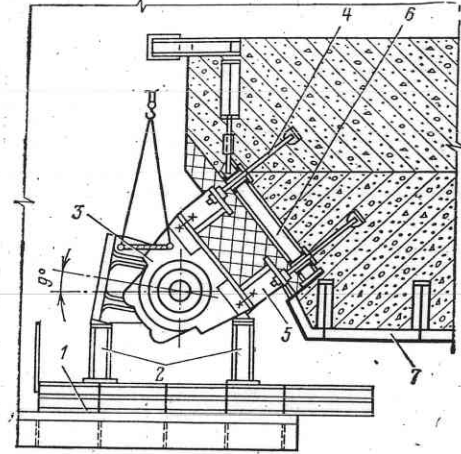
Схема монтажа шарнира сегментного затвора на опорной балке:
